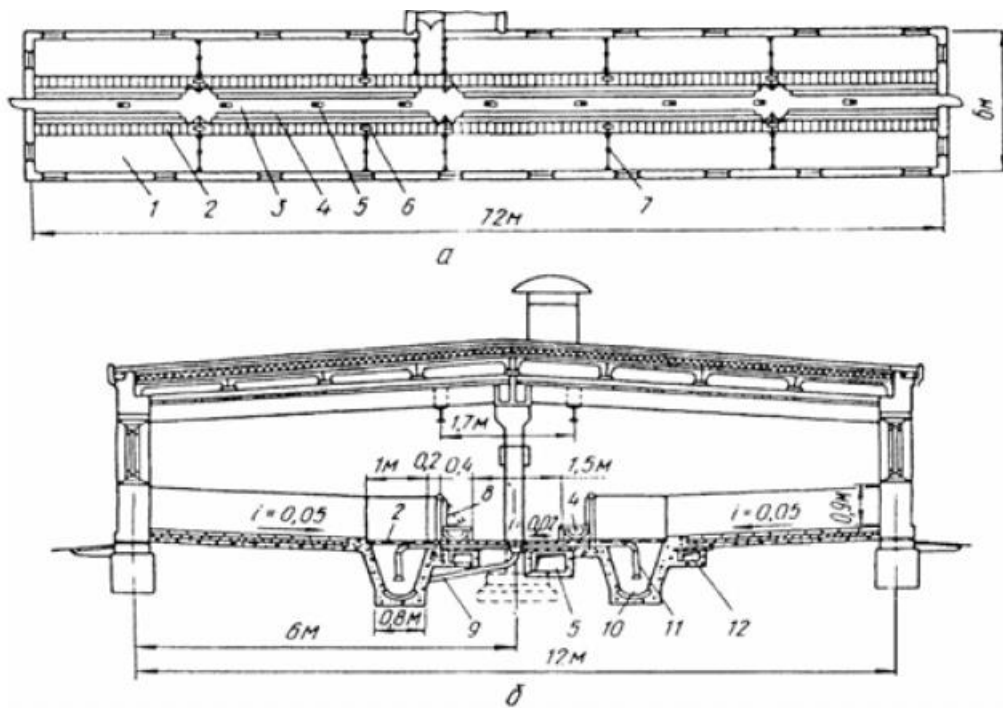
Свилярник-вiдгодiвельник: *a* – план; *б* – поперечний розрiз; 1 – лiгво; 2 – рiшiтчаста пiдлога; 3 – кормовий прохiд; 4 – годiвниця; 5 – припливна вентиляцiя; 6 – напувалка; 7 – перегородка; 8 – поворотнi рiшiтки; 9 – зливна труба; 10 – канал гiдравлiчної системи видалення гною; 11 – трубопровiд; 12 – витяжна вентиляцiя
